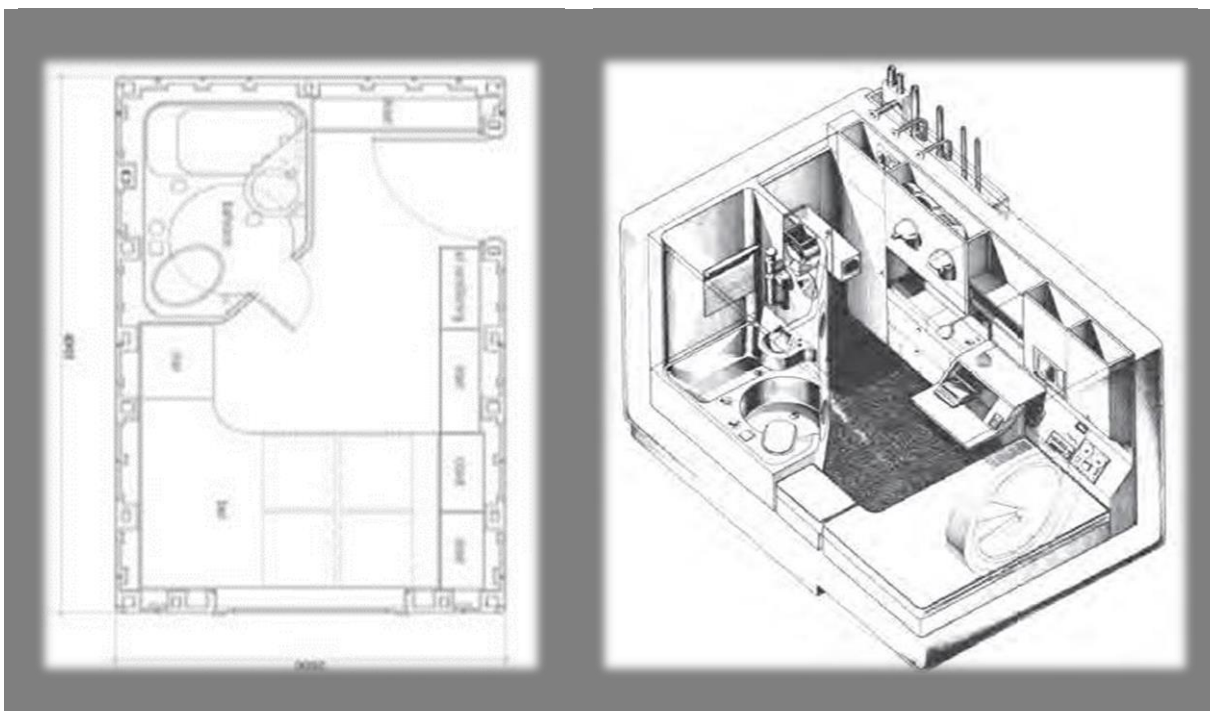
Planta arquitectónica e isométrico del proyecto “Nakagin capsule tower”. Fuente: (Pastrana, 2017).
